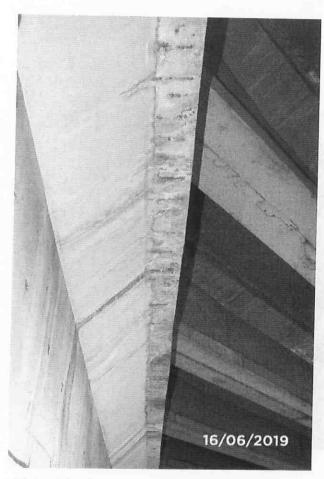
Armadura exposta na viga de travamento transversal sobre os pilares centrais.
